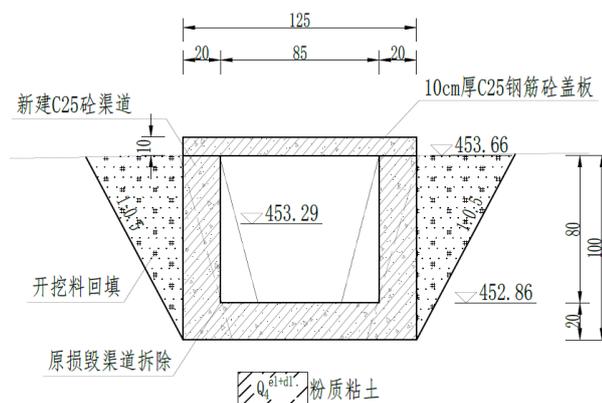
MQZ1.K0+000.00~MQZ1.K0+678.47 段渠道典型横断面图
